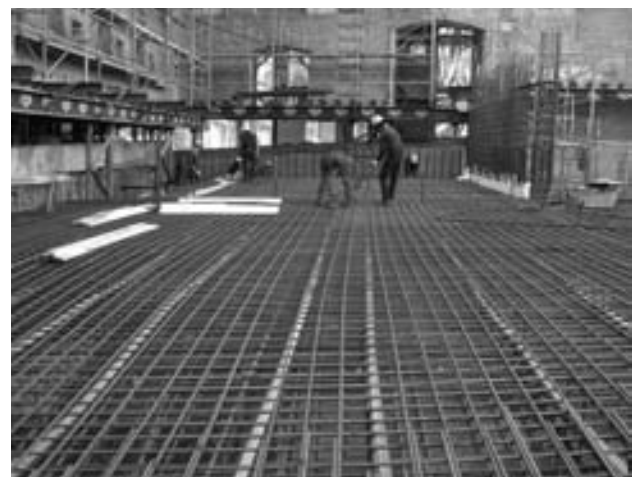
Losa postesada sobre auditorio. Disposición de las vainas y armado.
